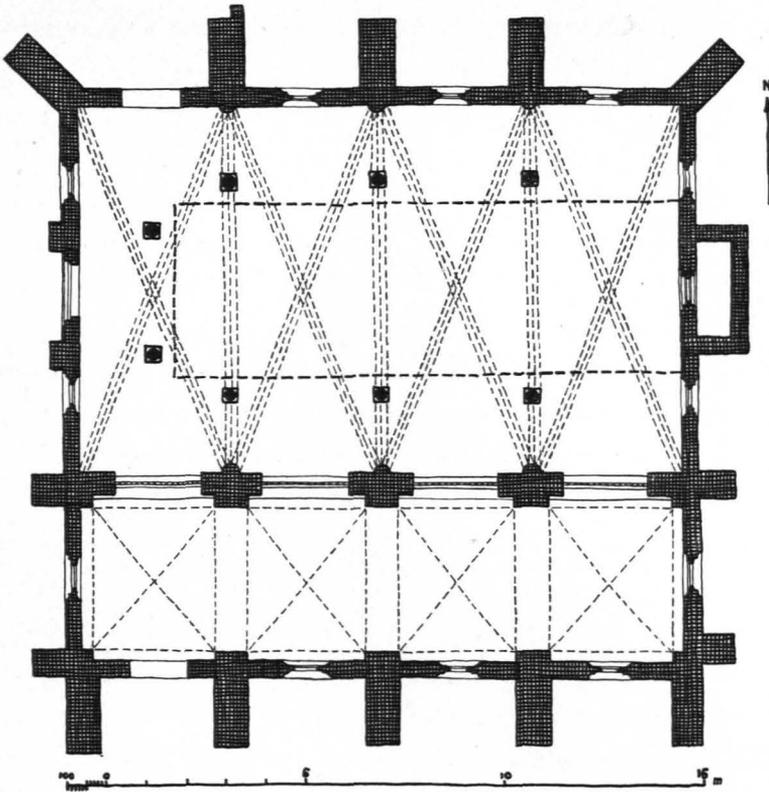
Grundriß von 1831 (nach Plan bei den Bauakten)
